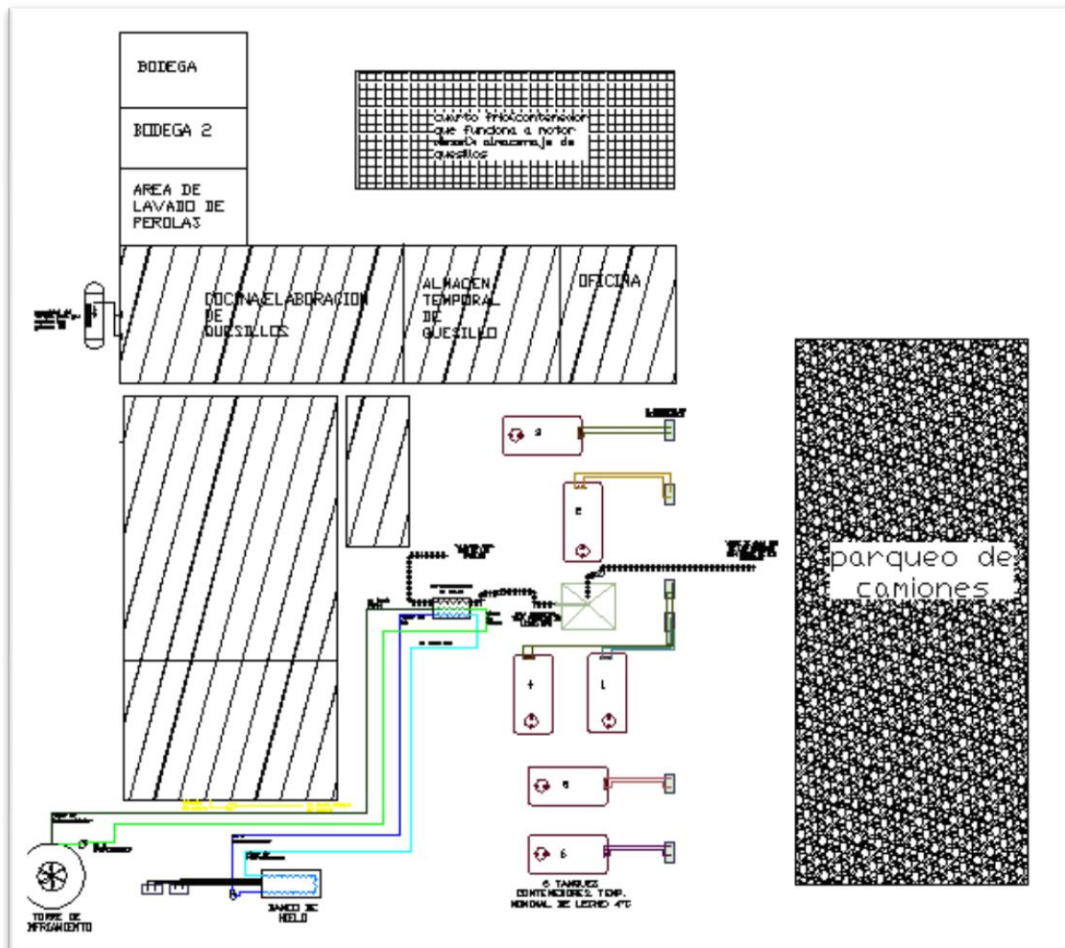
Esquema del sistema de refrigeración de la Planta Lácteos San Sebastián.
